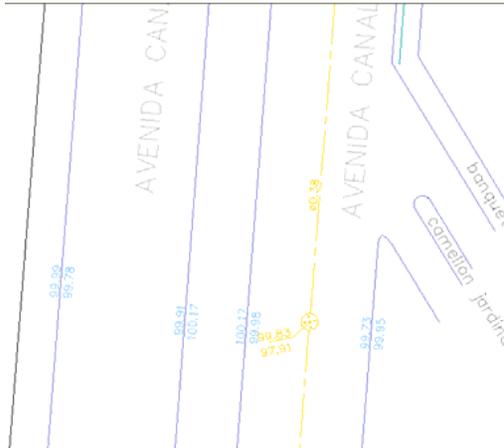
Los números azules representan los niveles En guarnición, calle, camellón, etc. Av. Canal de Tezontle. Red de drenaje (amarillo). Nivel de brocal (arriba 99.83) Nivel de plantilla (abajo 97.91) Ø de tubo 38.
